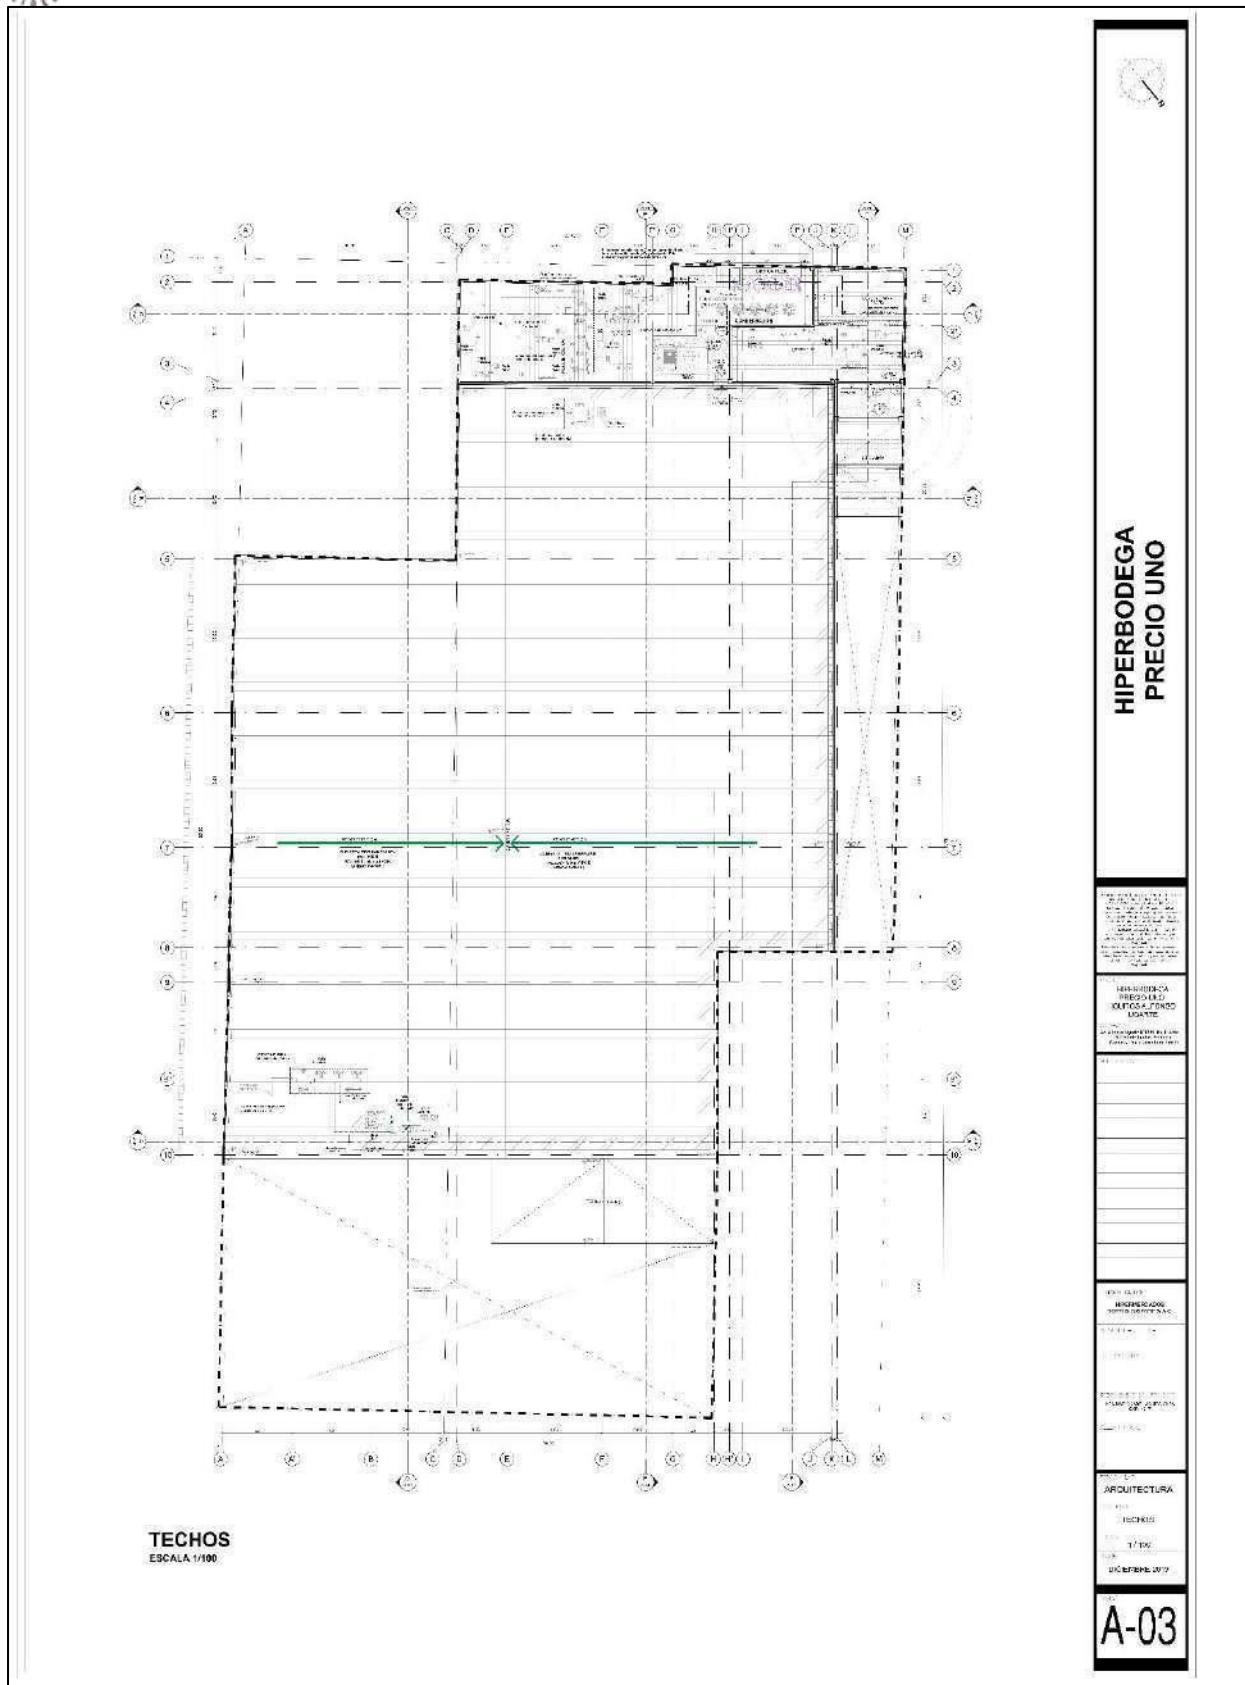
Plano Nivel techo- Iquitos Alfonso Ugarte
